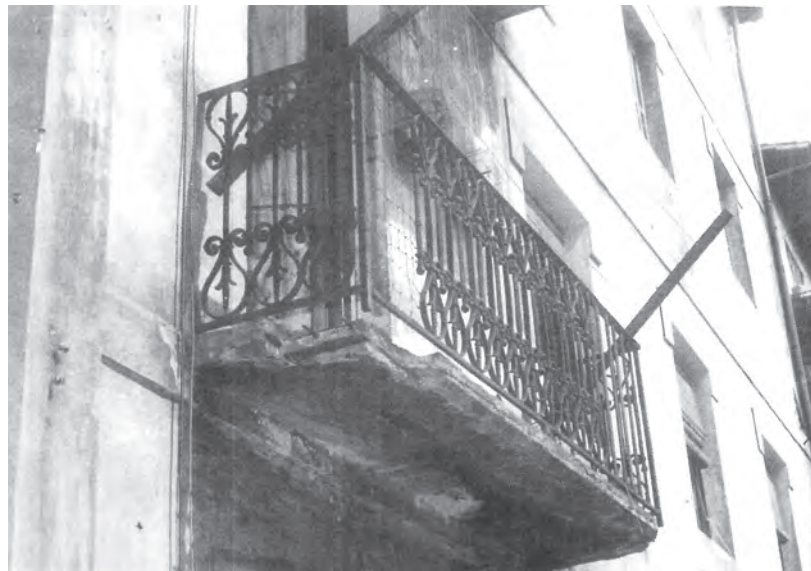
26. 1974. FOTOGRAFÍA DEL BALCÓN UBICADO EN LA SEGUNDA PLANTA EN LA FACHADA TRASERA¹⁵
